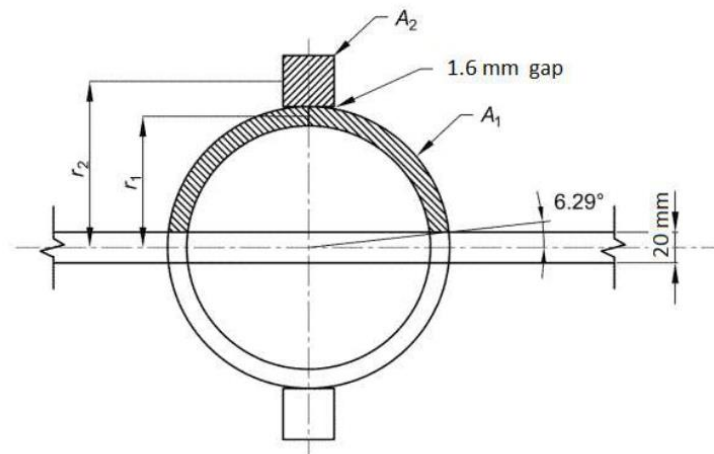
Sección transversal del arriostramiento inferior de la viga.
